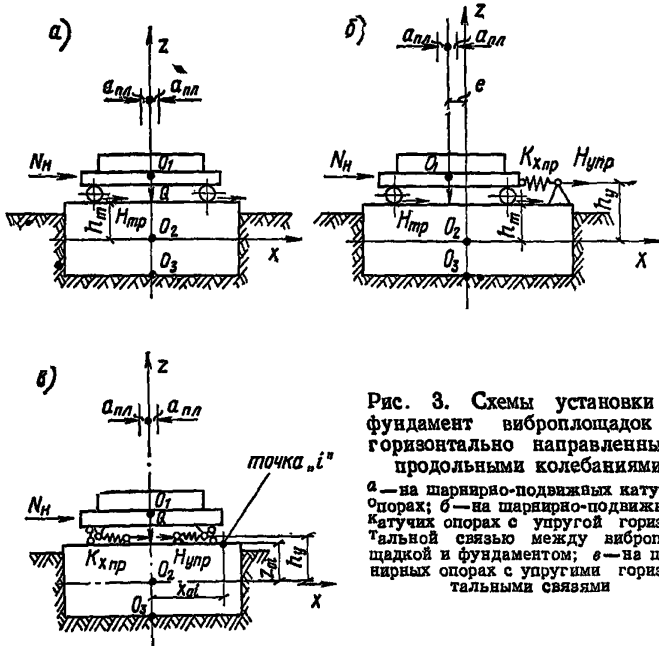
Схемы установки на фундамент виброплощадок с горизонтально направленными продольными колебаниями
